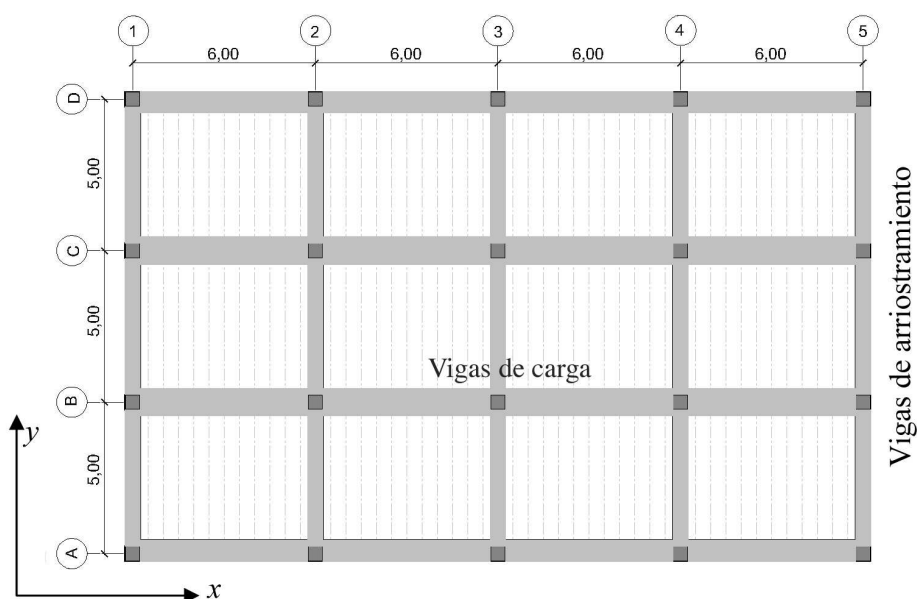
Planta típica del edificio con vigas planas (igual en todos los niveles).
